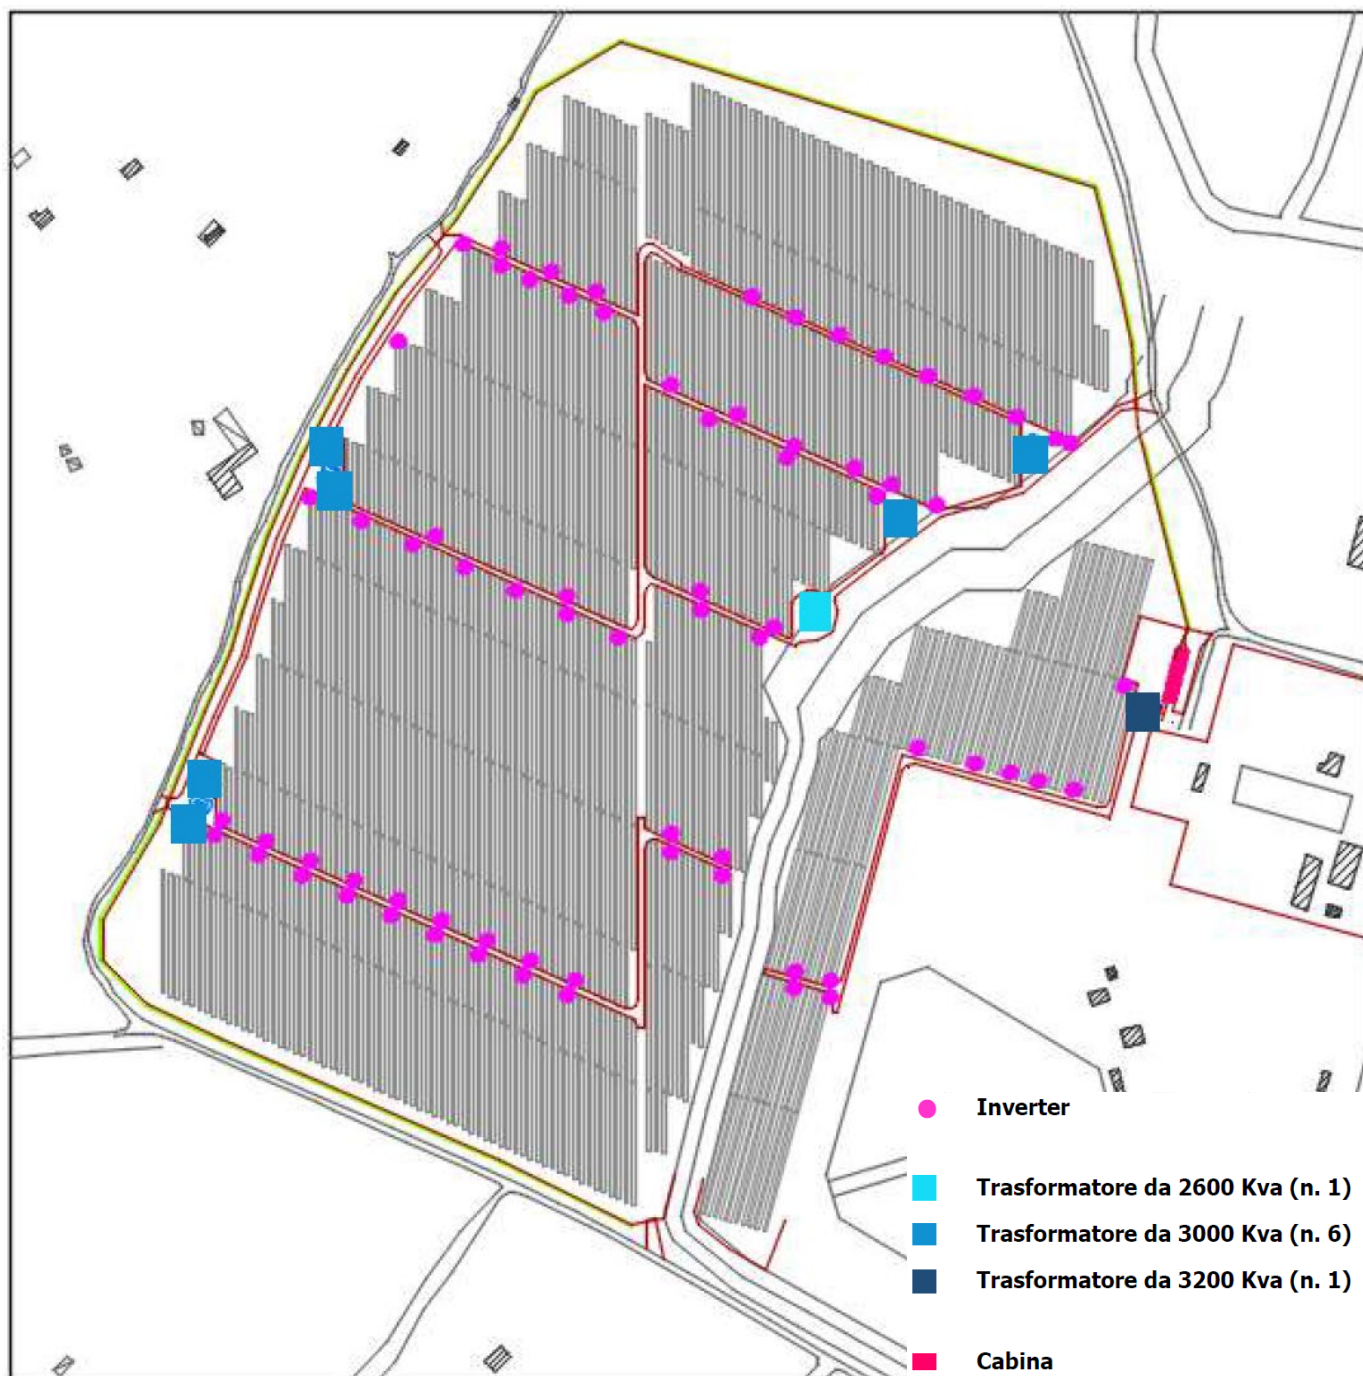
Planimetria con localizzazione delle sorgenti di progetto
